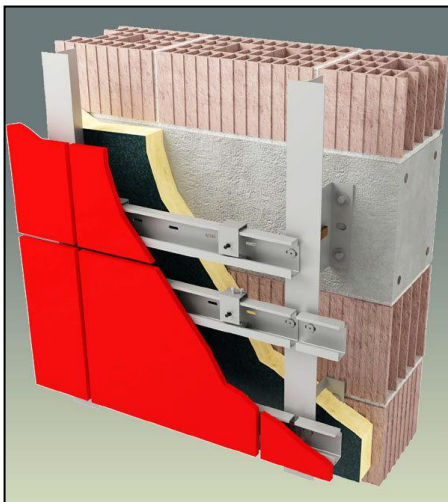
Detall constructiu de façana ventilada amb revestiment de panells de resina sintètica.
